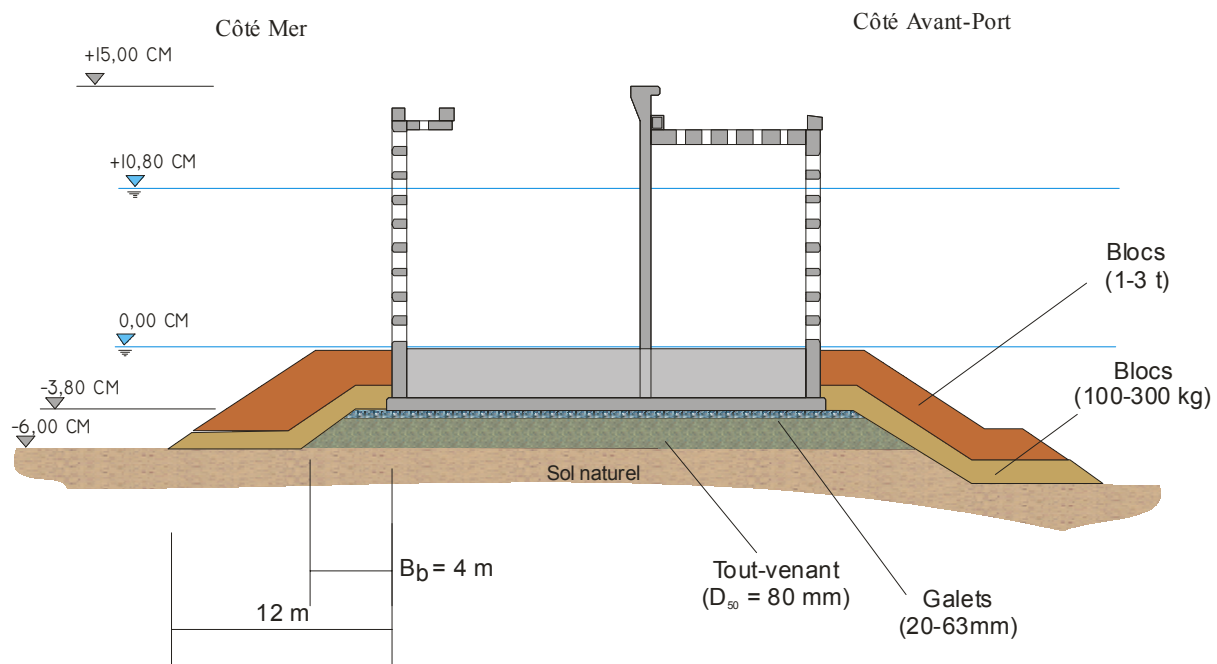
Coupe du caisson lesté sur sa berme.
